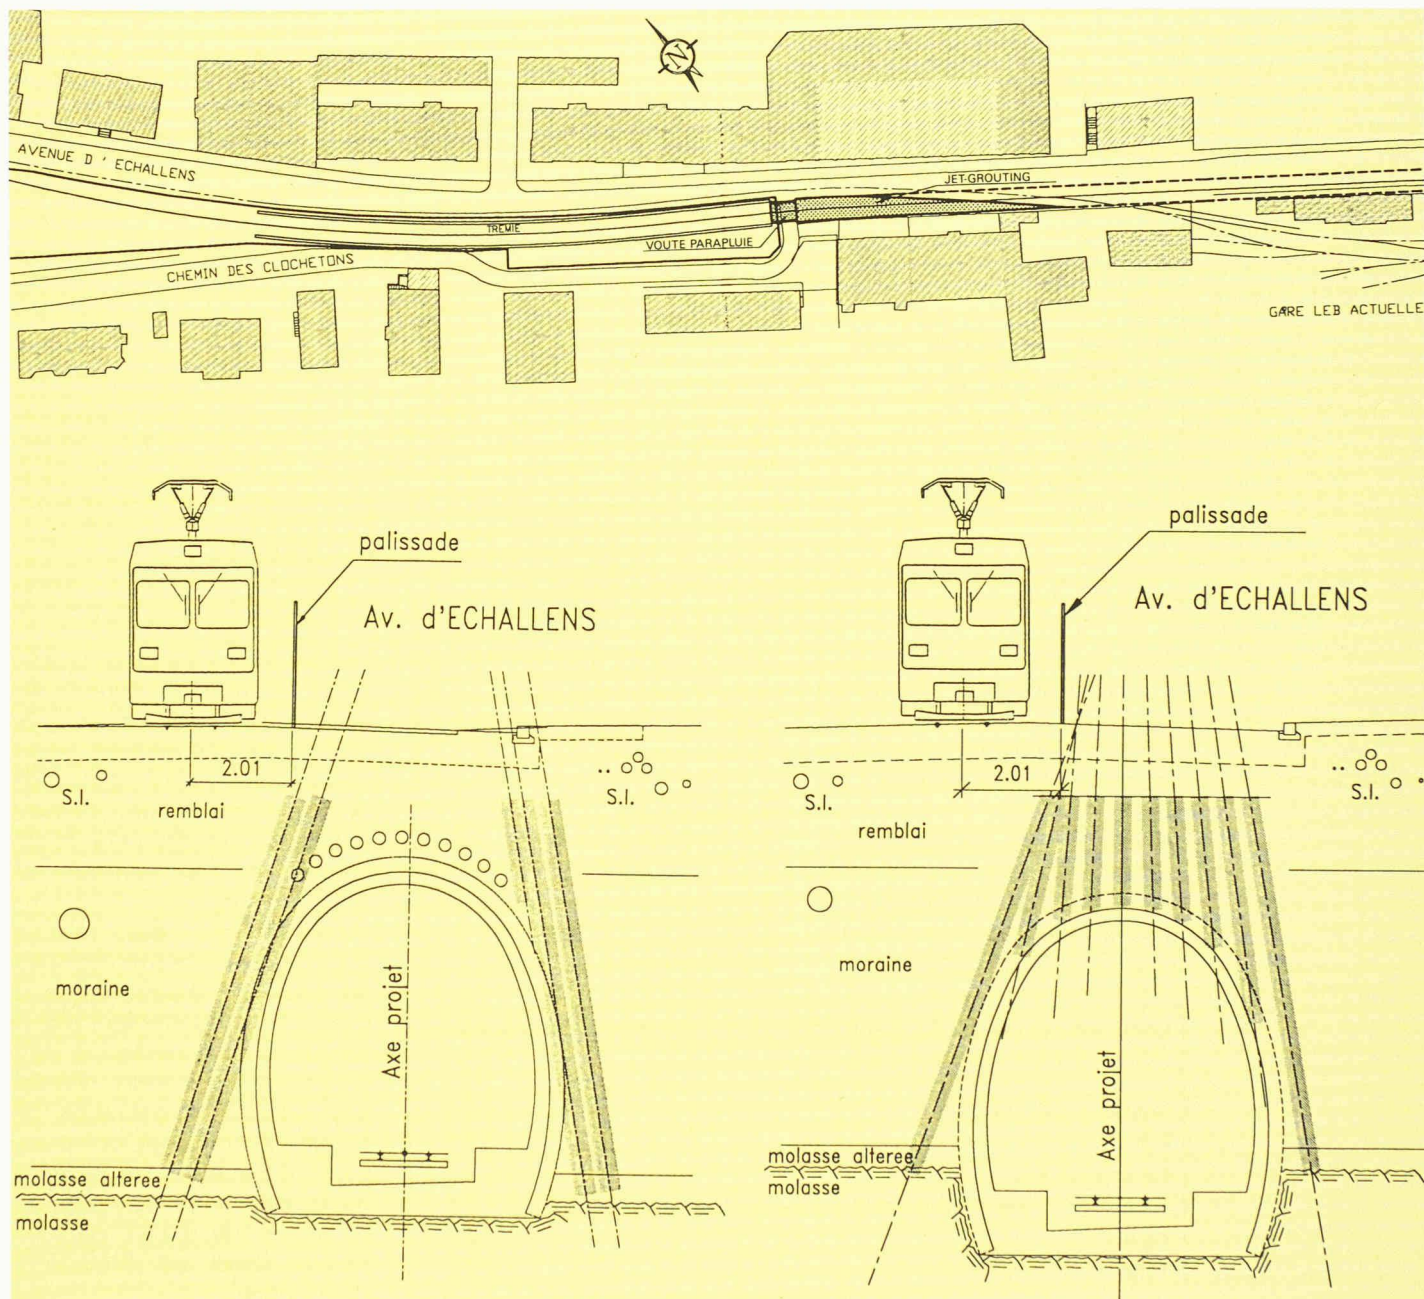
Tunnel de l'avenue d'Echallens: renforcement du terrain par voûte parapluie et par jet-grouting: a) situation, b) coupe au droit du portail, c) coupe type
